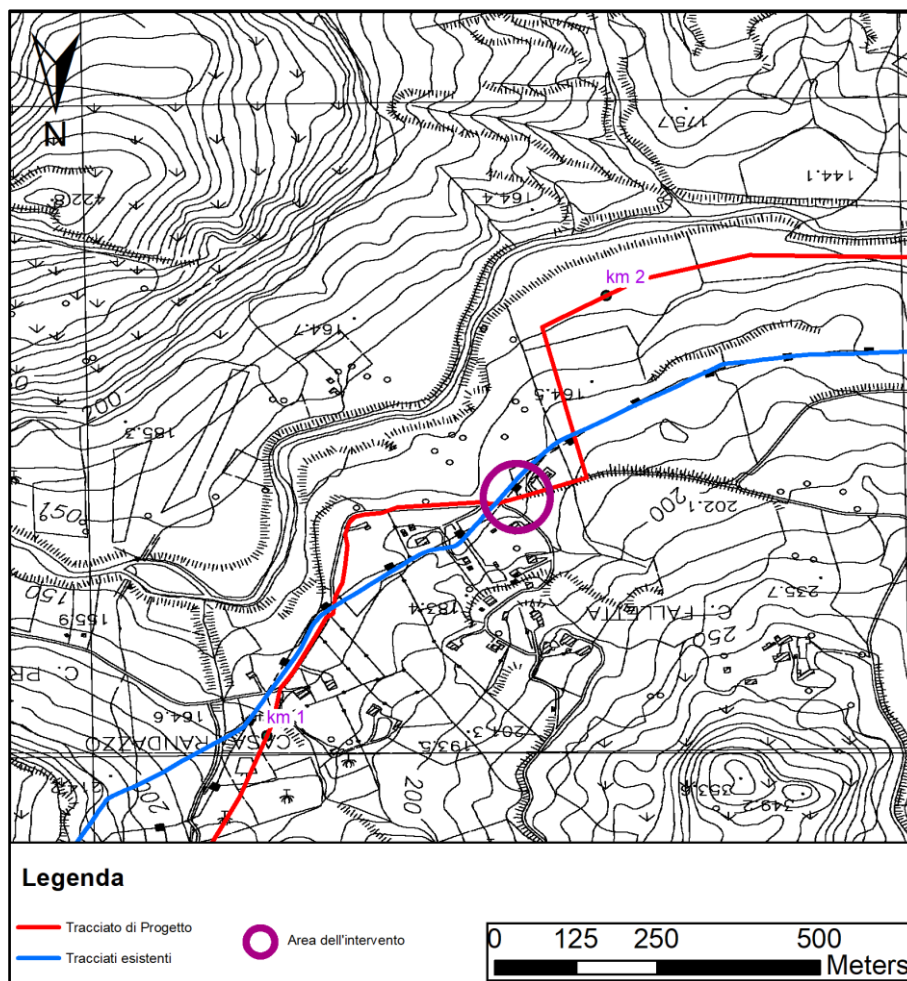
Planimetria dell'area dell'intervento, scala 1:10000
